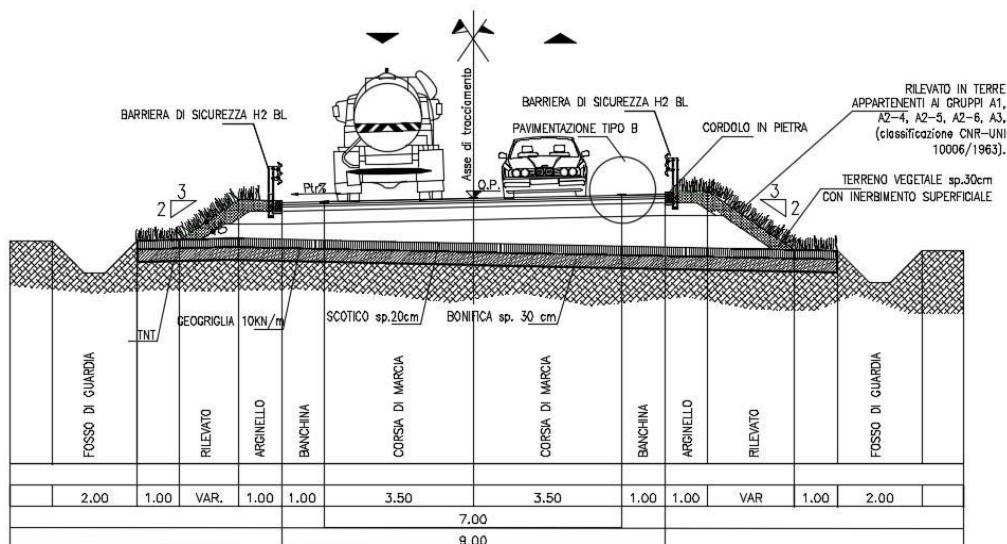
Sezione tipo "Bretella di collegamento tra R1 ed R2"
